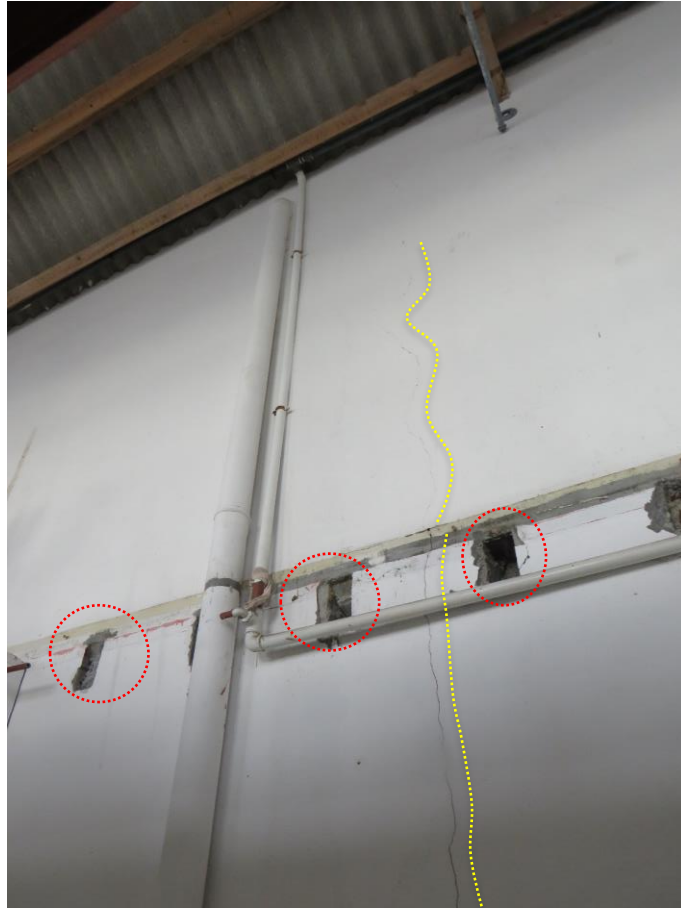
Fissura vertical no paramento interior da parede Norte. Marcas do apoio de vigas de pavimento do Piso 1.
